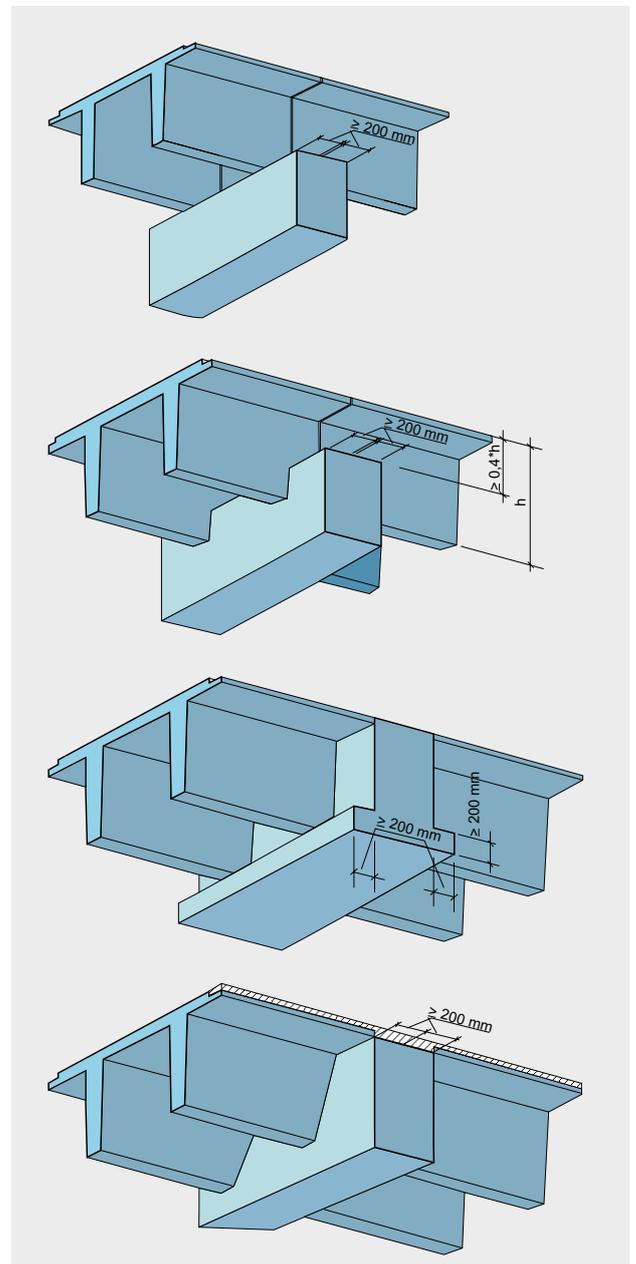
Auflager TT-Platten, unten mit Stahlaufleger
